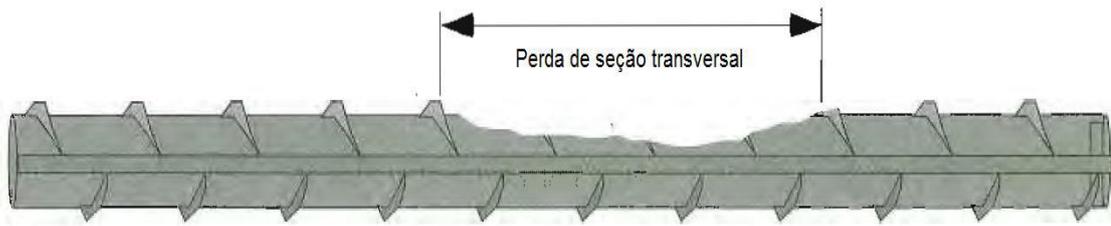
Processo de deterioração da armadura devido à corrosão
